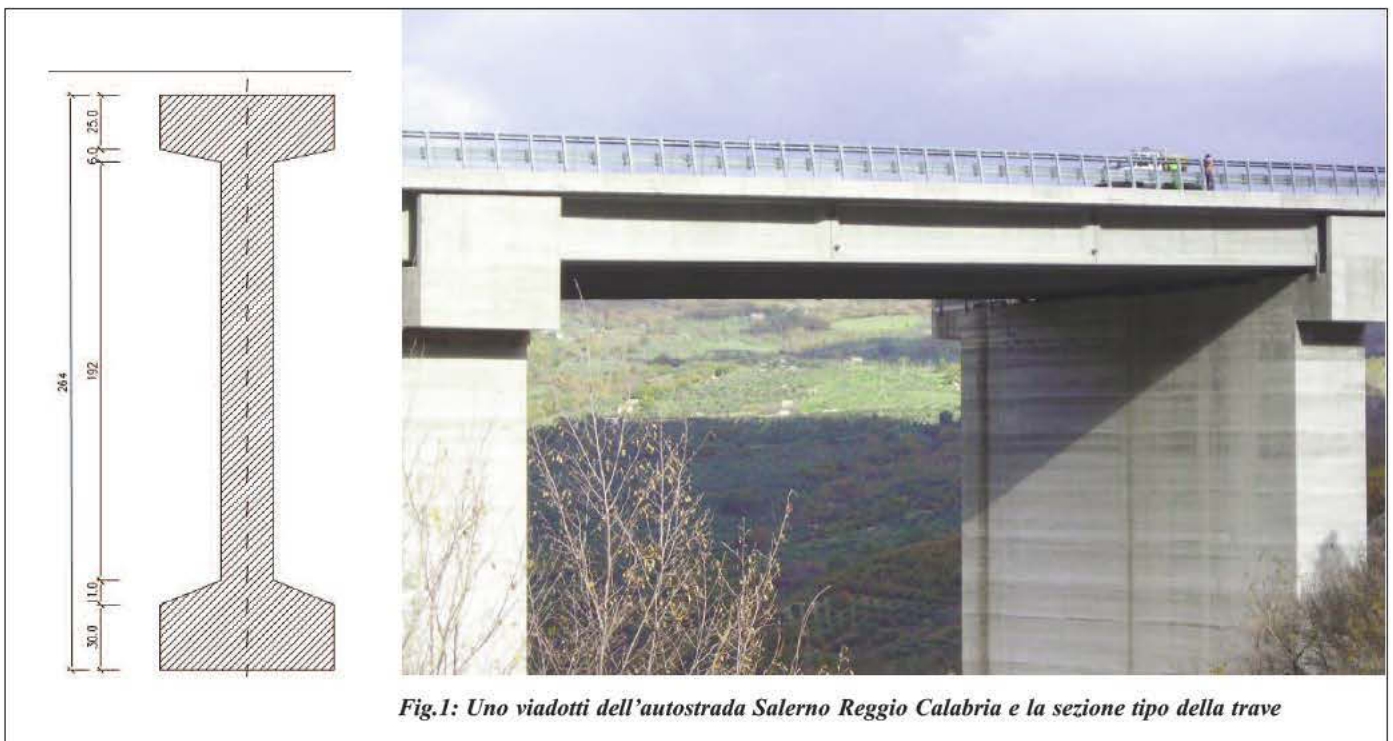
Uno viadotti dell'autostrada Salerno Reggio Calabria e la sezione tipo della trave
